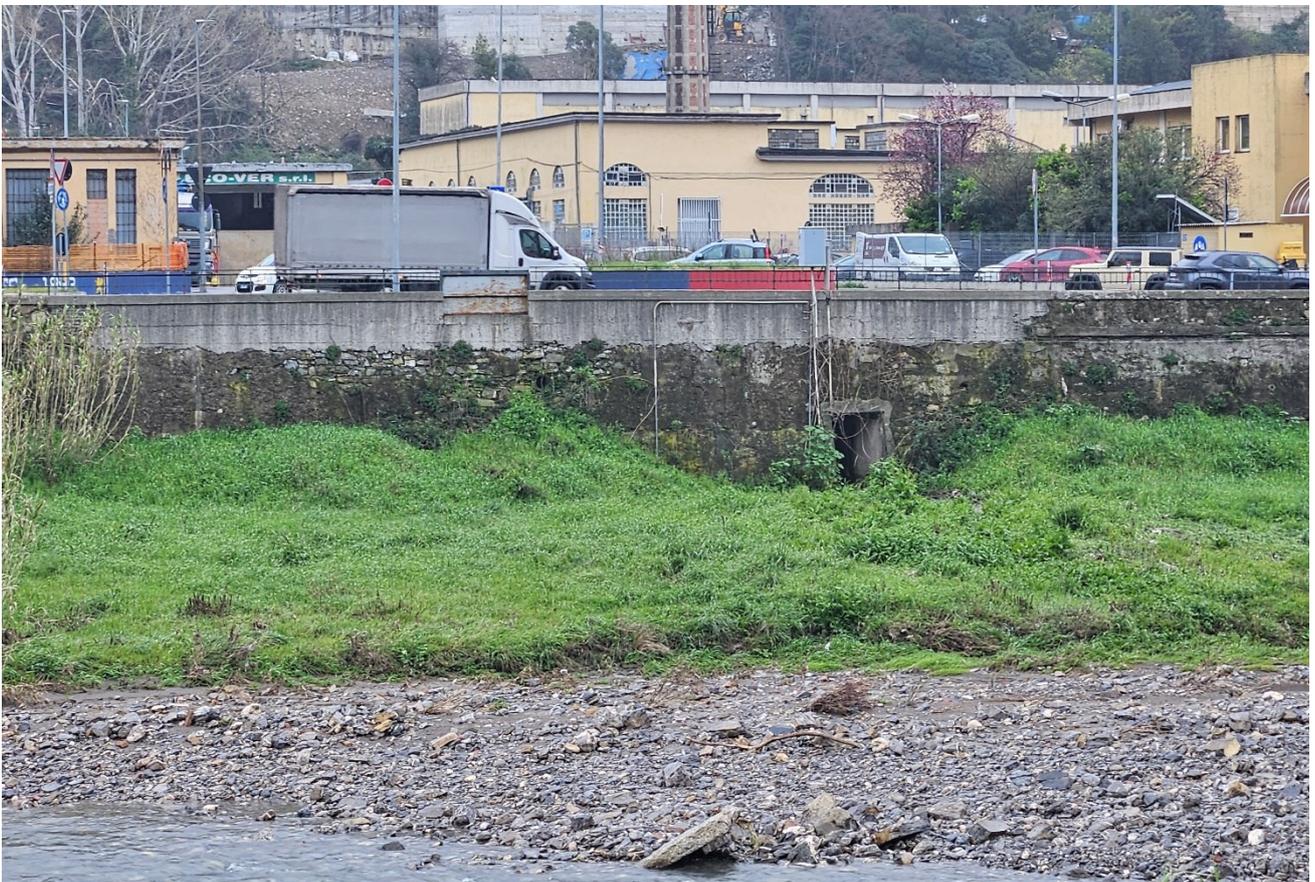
Dettaglio argine sinistro tipologia mista pietra e cemento armato
